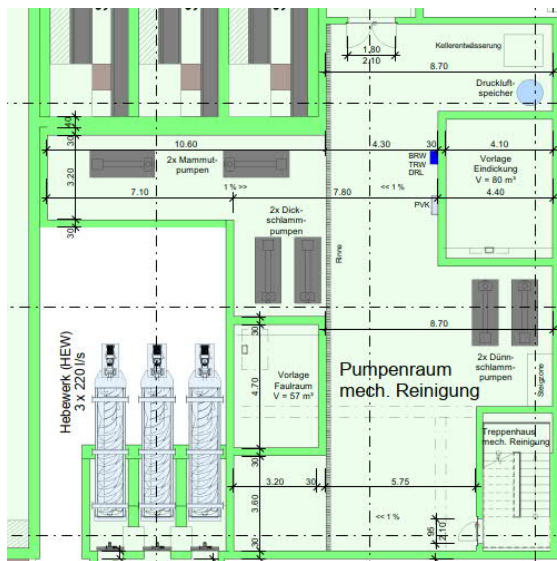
Planausschnitt; Grundriss UG
